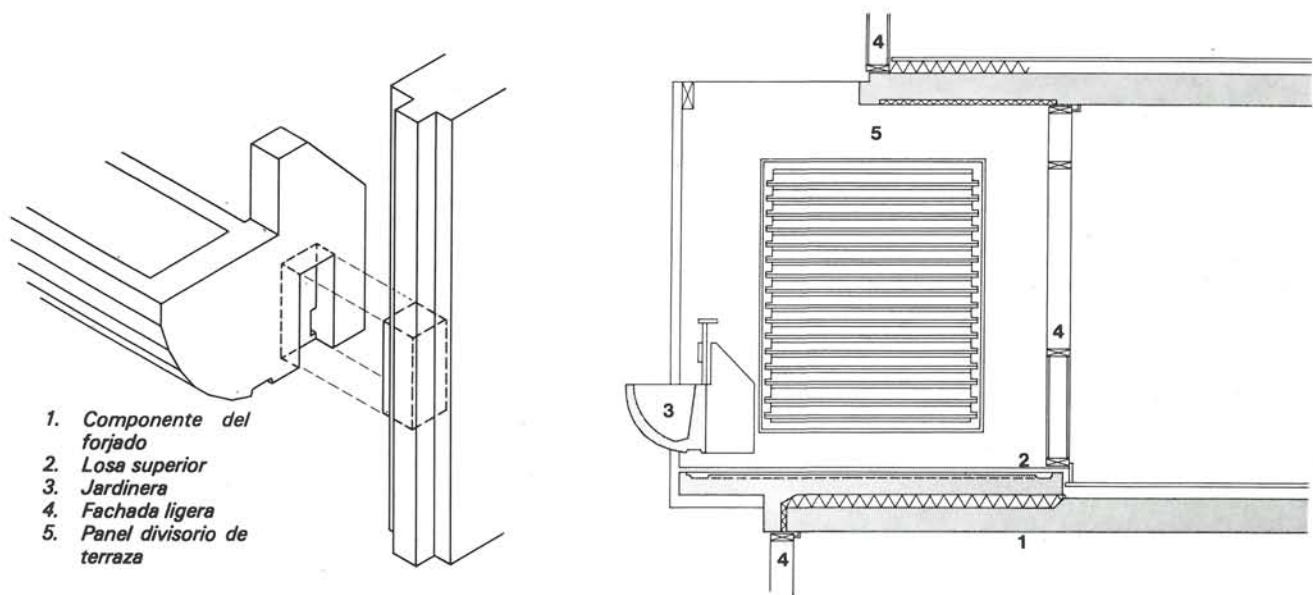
Detalle de la sección vertical de la zona de terraza.
